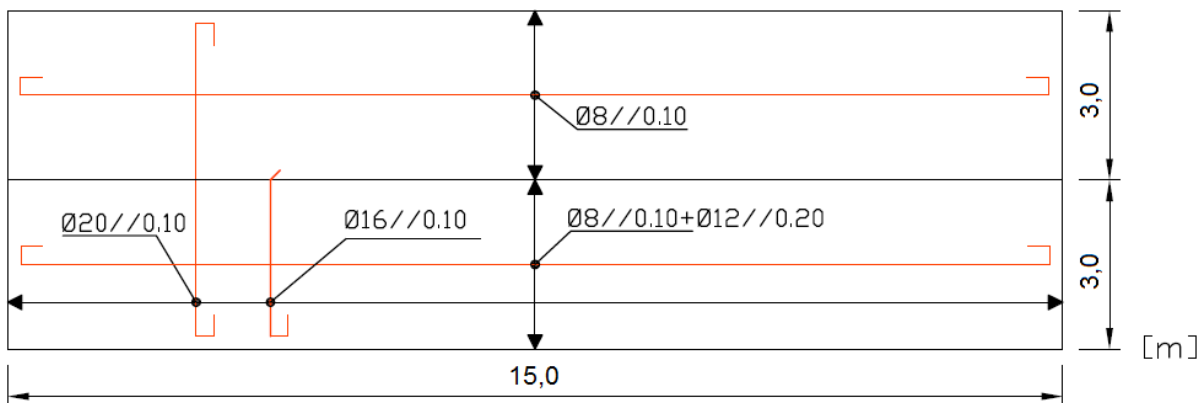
Desenho das armaduras longitudinais na face posterior (superior).
